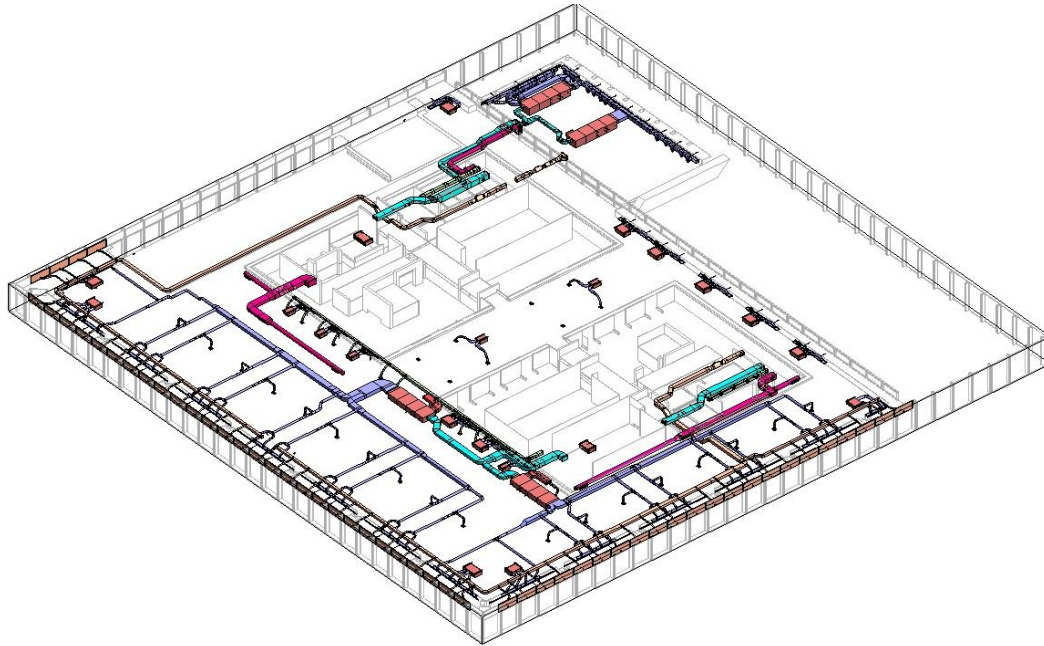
Rappresentazione modellazione aeraulica piano tipo (Immagine estratta da elaborato Revit tesi)
